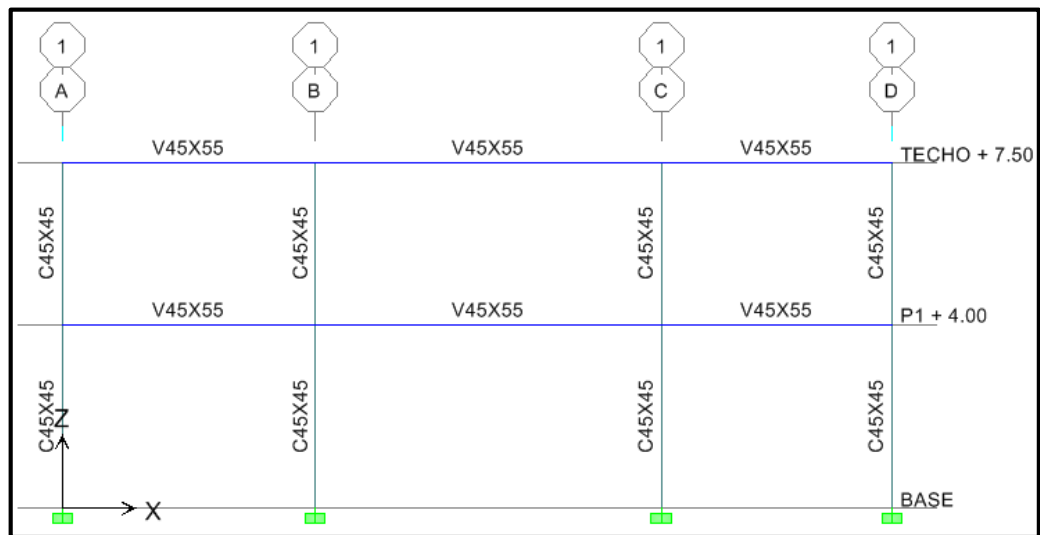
Secciones Finales de Columnas (Pórtico 1)
